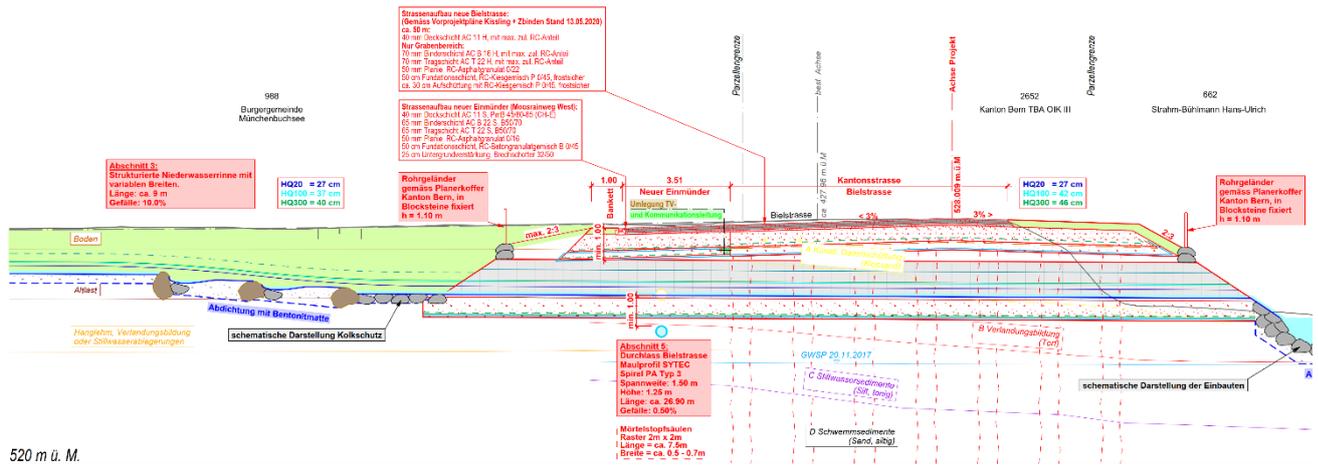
Ausschnitt Detailplan Schnitte Durchlass Bielstrasse Stand Wasserbauplan, 26.07.2024
